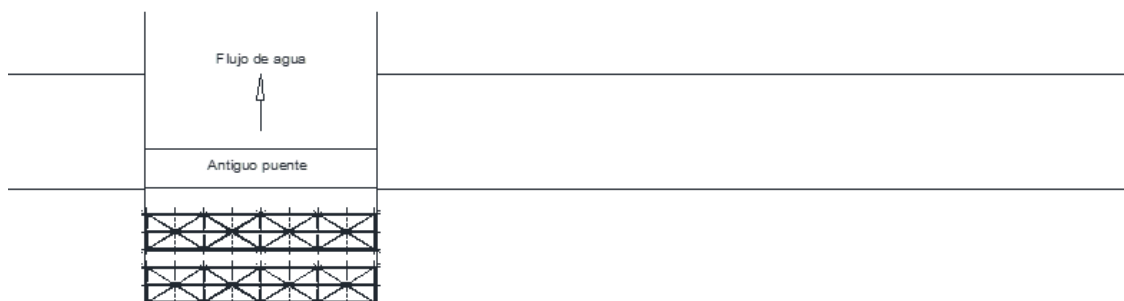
Segundo trio de vigas ubicados en su posición final
